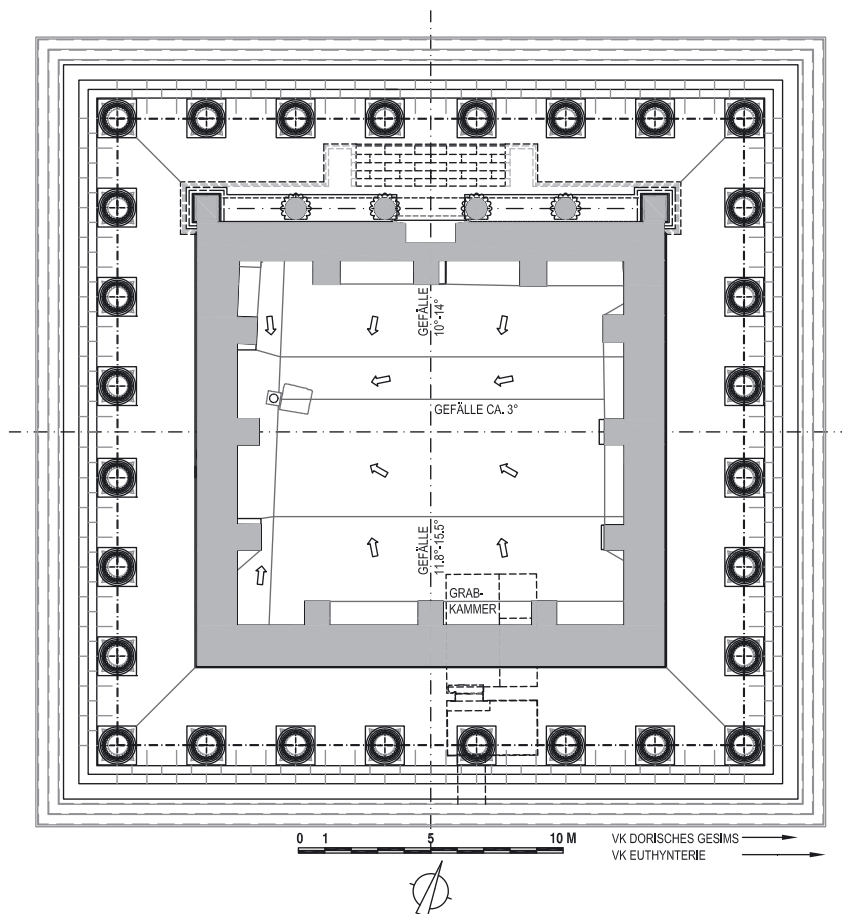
Grundriss des Obergeschosses – Rekonstruktion, M = 1 : 200
